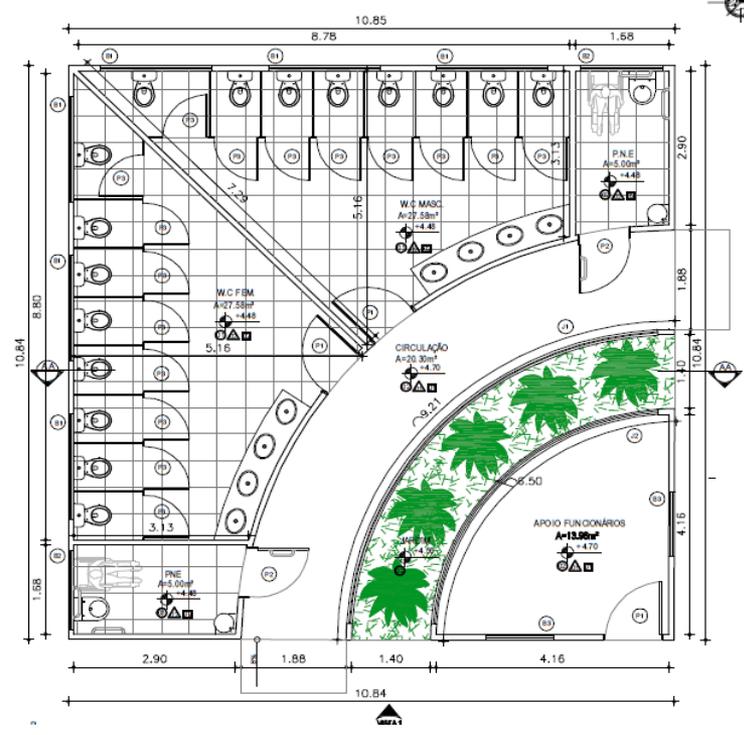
Planta de cobertura bloco de banheiros e apoio/ Fonte: A autora, 2017.
